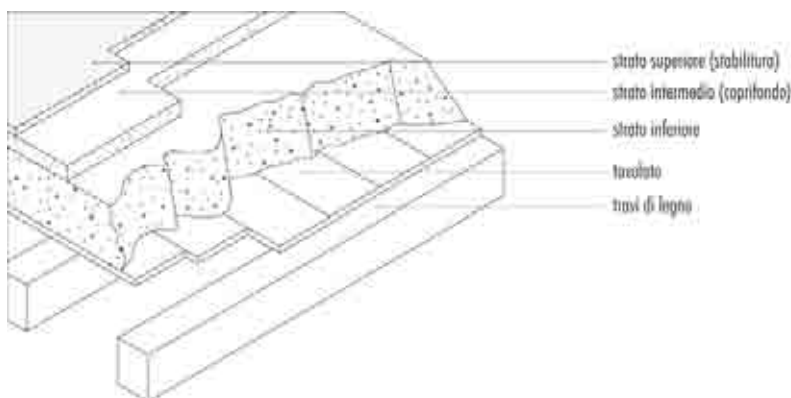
Stratificazioni di una pavimentazione tradizionale in cocchiopesto.
